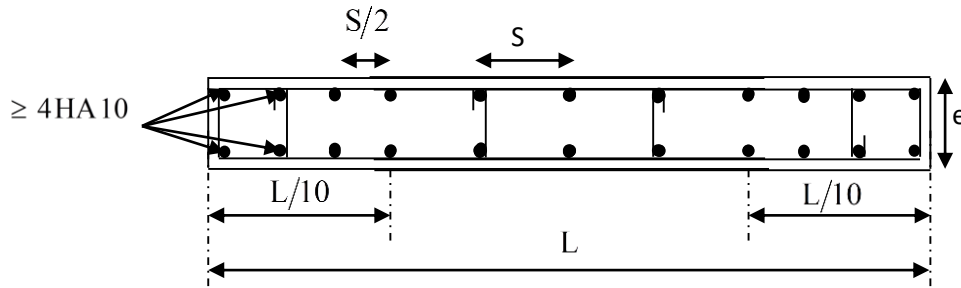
Disposition des armatures verticales dans les voiles.
